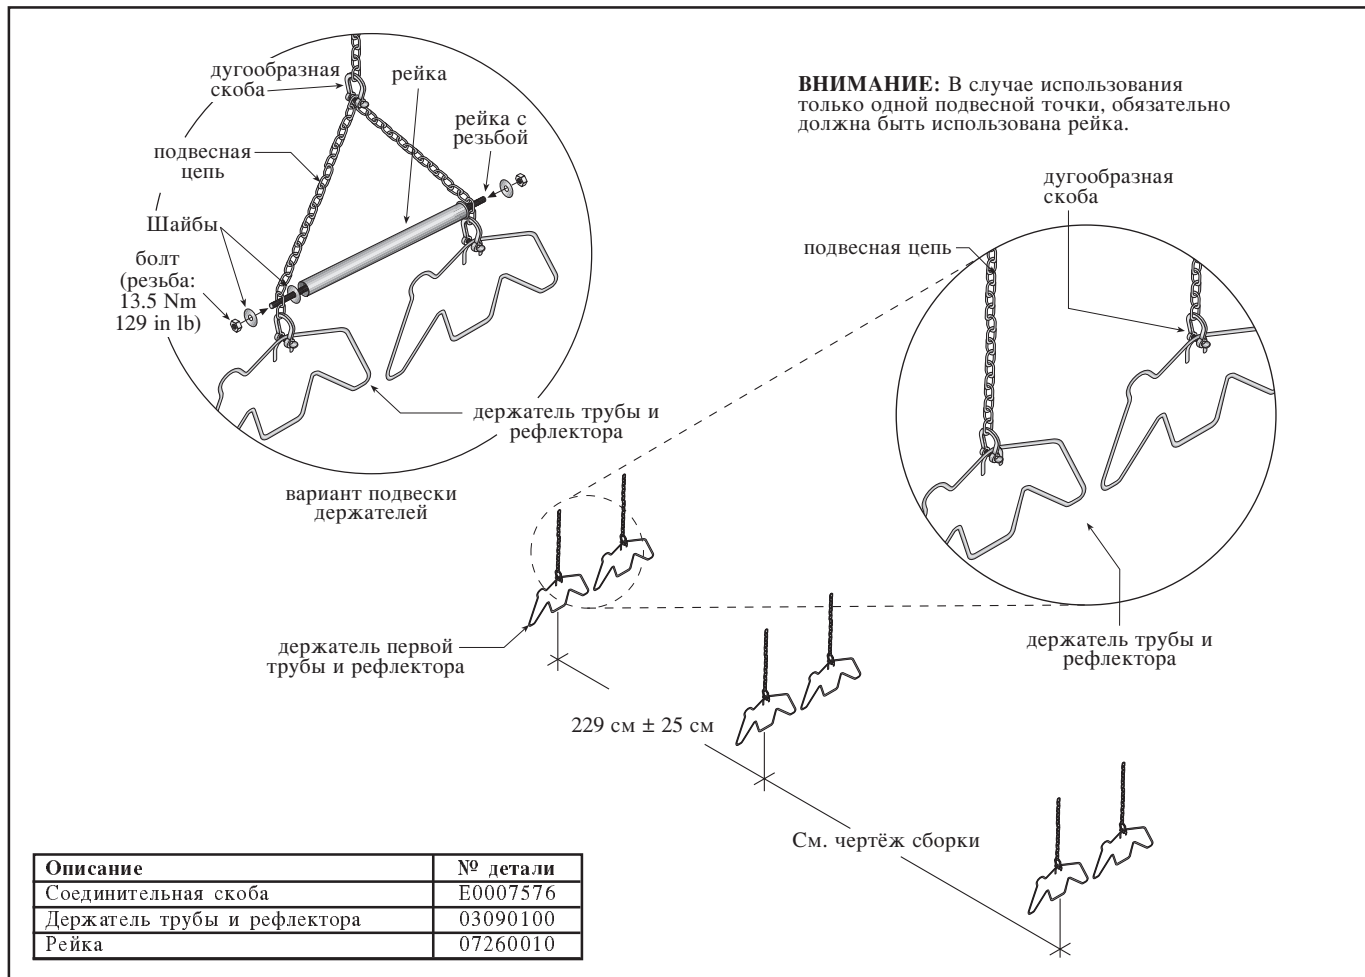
BLACKHEAT® Чертежи обогревателя U-образной формы
